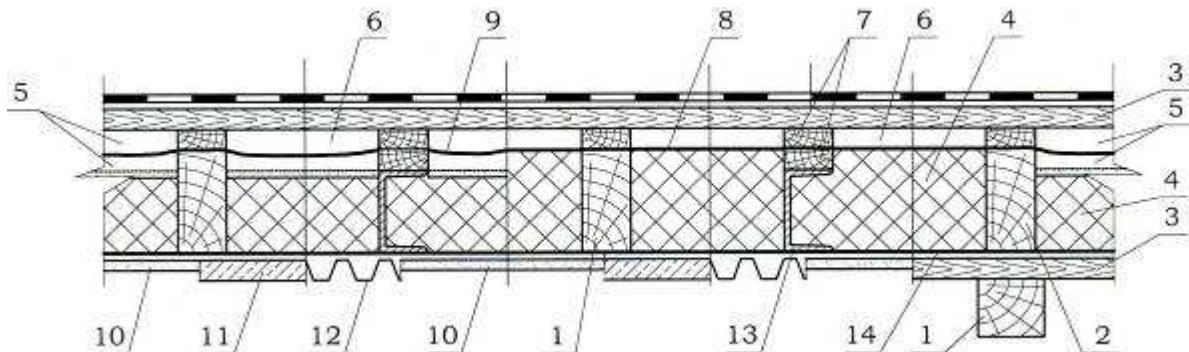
Утеплённые вентилируемые крыши с кровлей из гибкой черепицы
